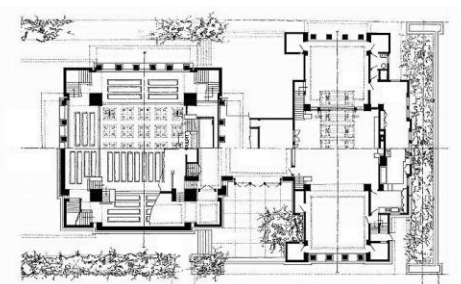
| Unity Temple Esquema planta térreo e seg. pav.
